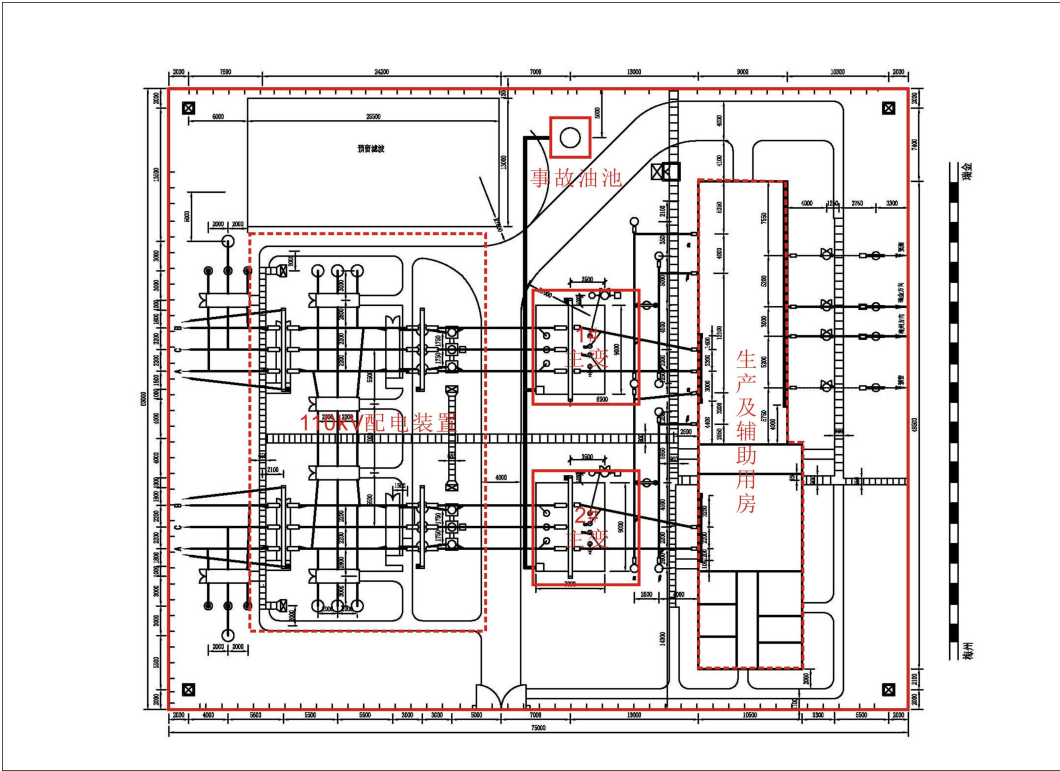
八尺、灵泉寺牵引变电所平面布置图
